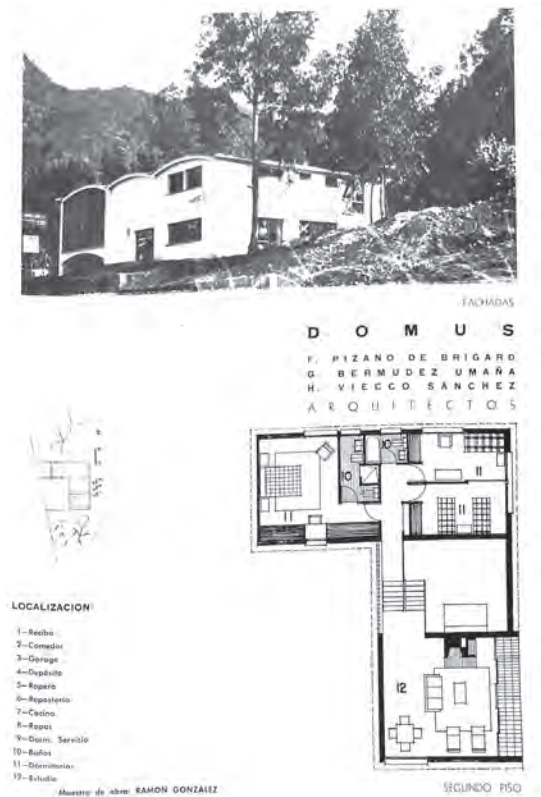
Casa Pizano (Pizano, 1950). Planta y fachada. Fuente: Revista Proa Número 44.
